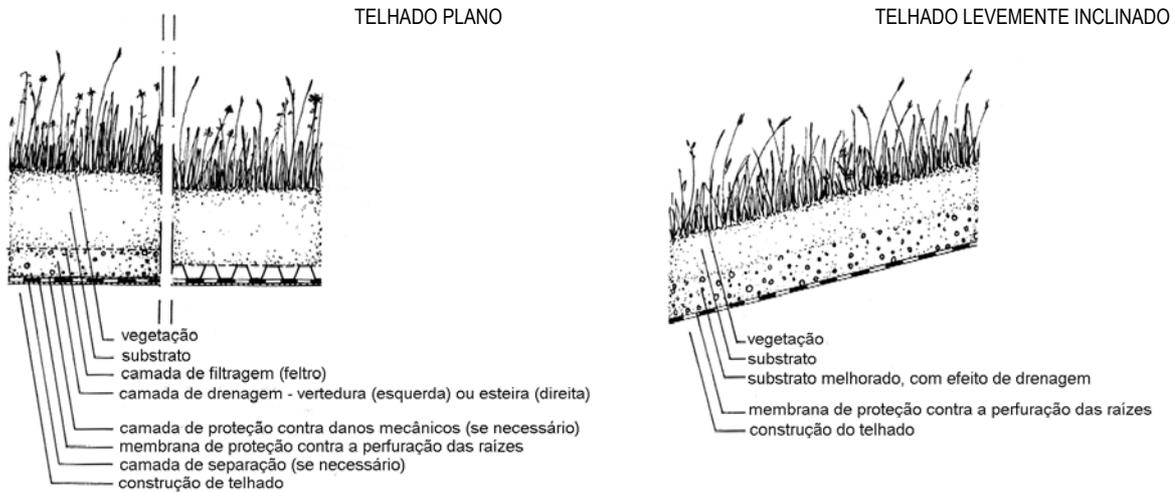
esquemas de construção de telhados planos e de telhados levemente inclinados (baseado em MINKE, 2004, p. 32)
